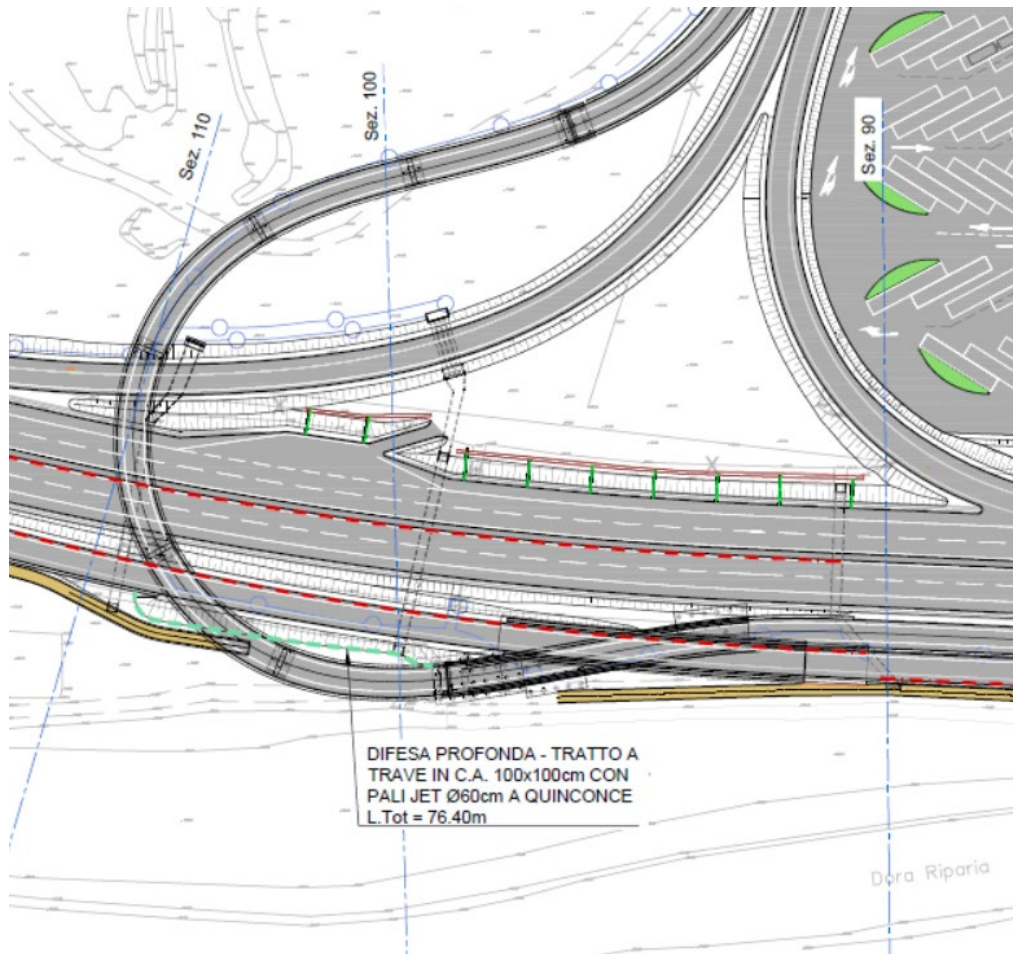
Estratto planimetria opera dalla tavola di progetto tratto di monte
